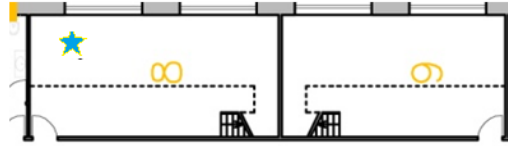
Pianta ufficio 8 - Soppalco. Il posizionamento dei Tinytag è indicato dalla stellina celeste.
